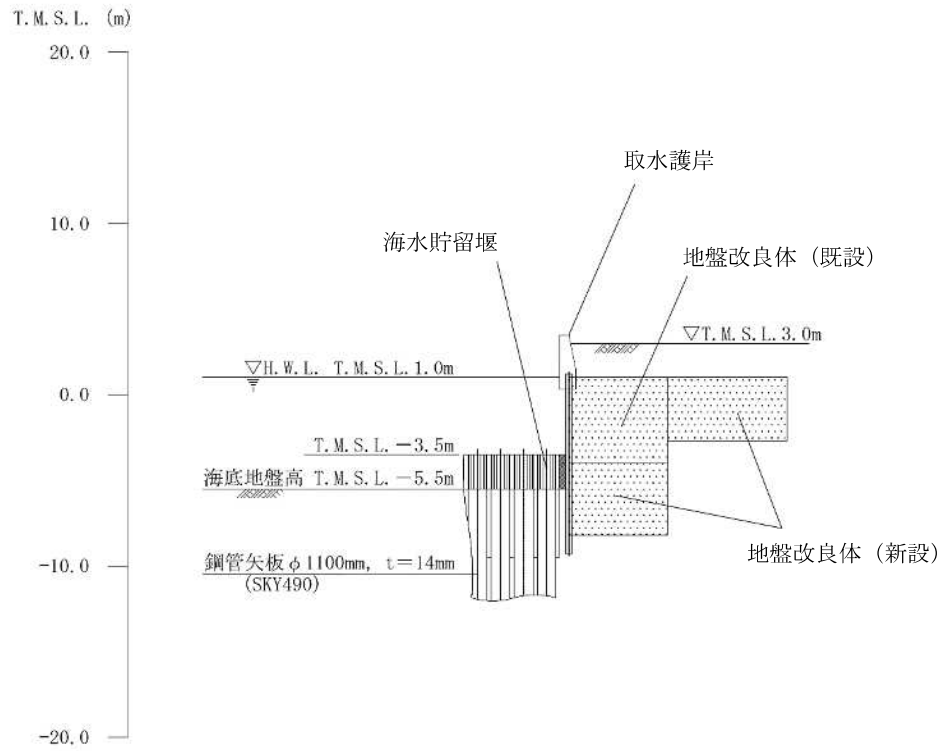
取水護岸の標準断面図 (A-A断面)
